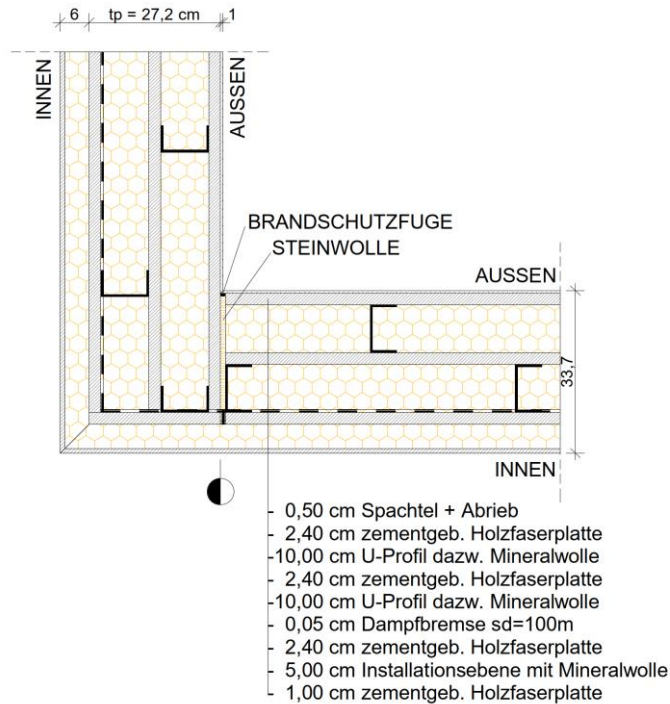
Grundriss Innenecke (Elemente gestoßen)
